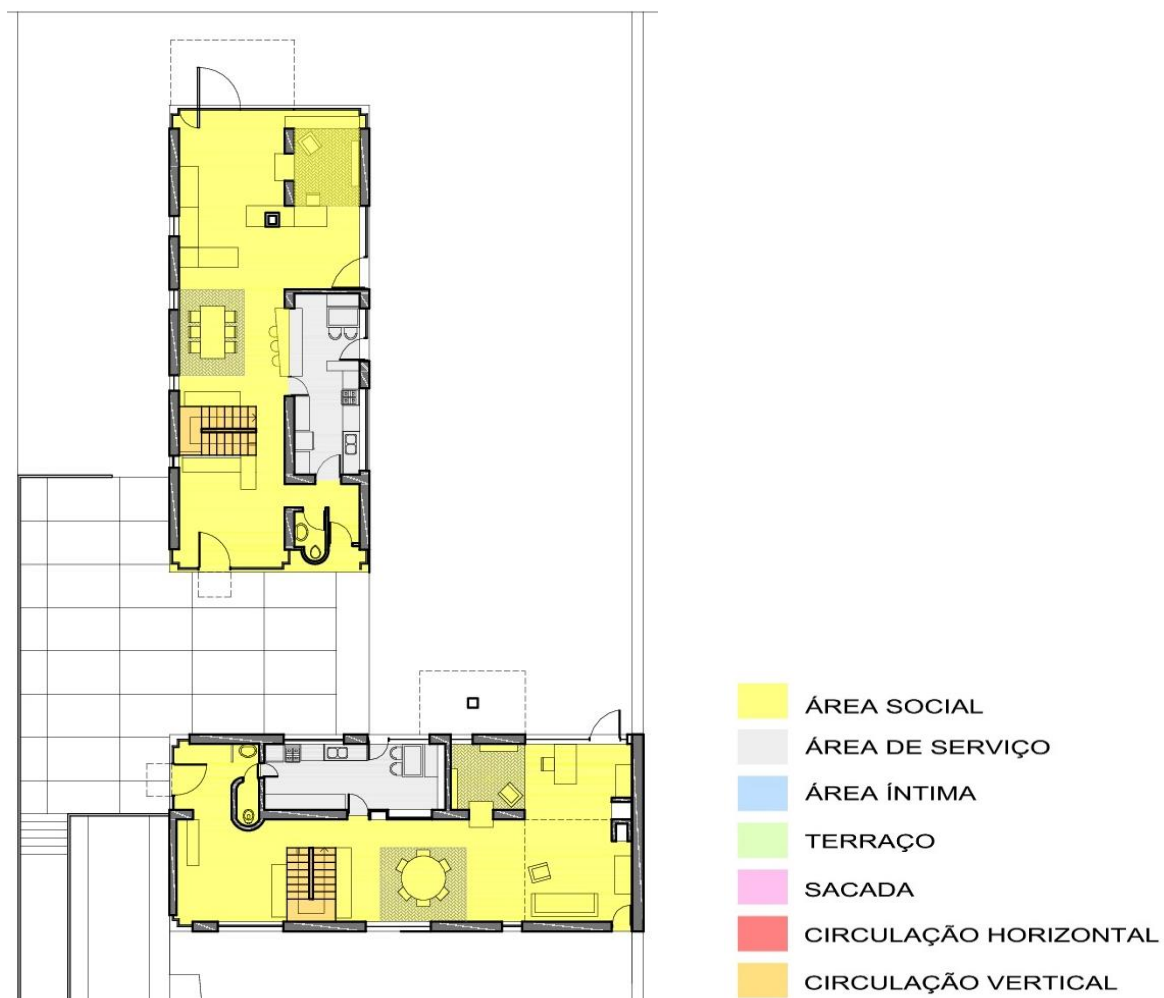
Maisons Jaoul – Zoneamentos pavimento térreo
